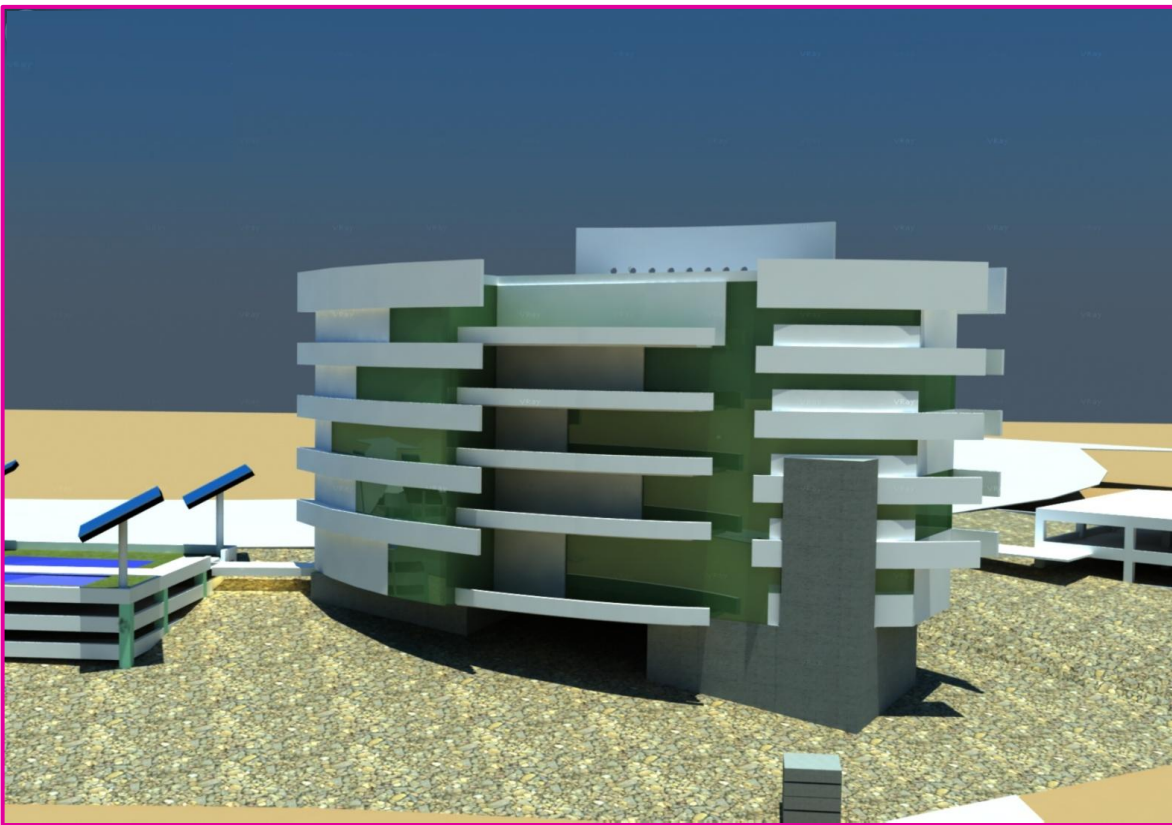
PRIMER PARTIDO ARQUITECTÓNICO. EDIFICIO CENTRAL.
